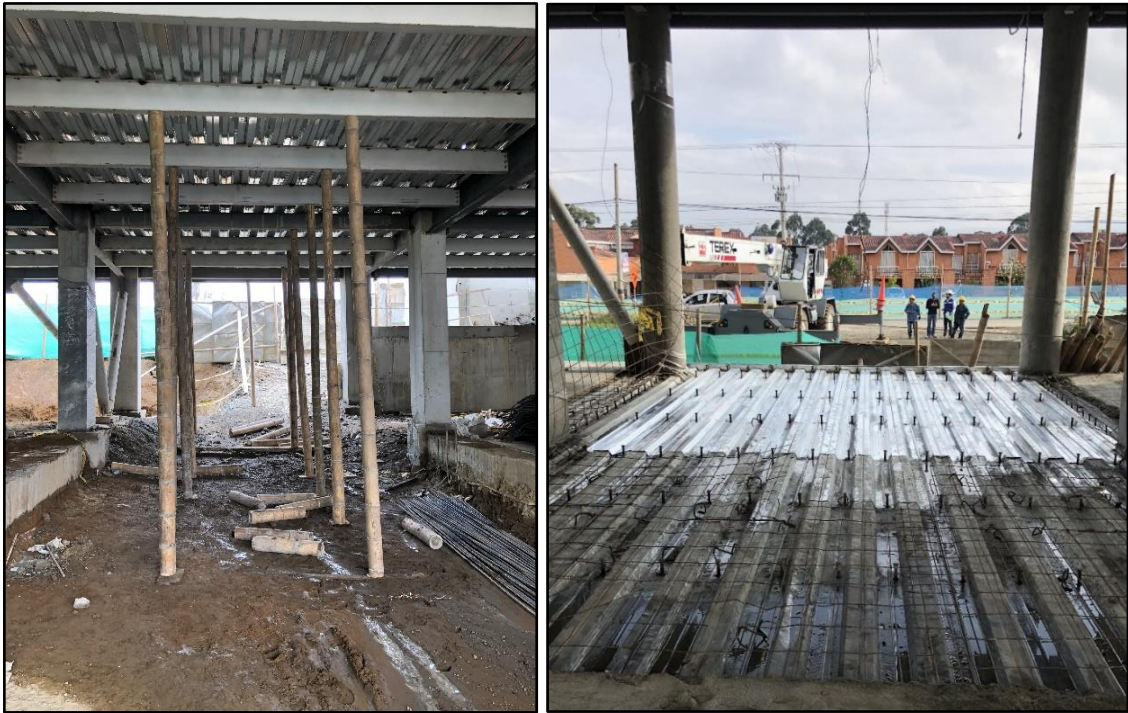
Soporte para la losa y Lamina Steel Deck. Fuente: tomada por el pasante.
